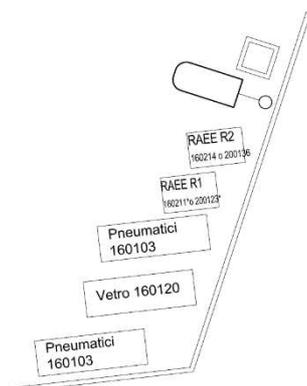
Straccio planimetrico relativo allo stoccaggio dei rifiuti nei cassoni nel piazzale esterno
